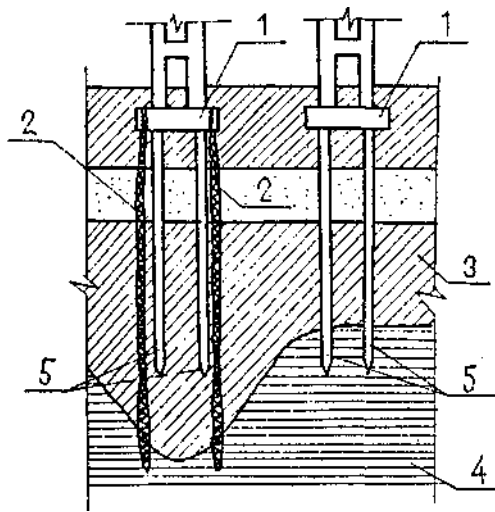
Передача навантаження від фундаменту на залізобетонні палі, занурювані задавлюванням
